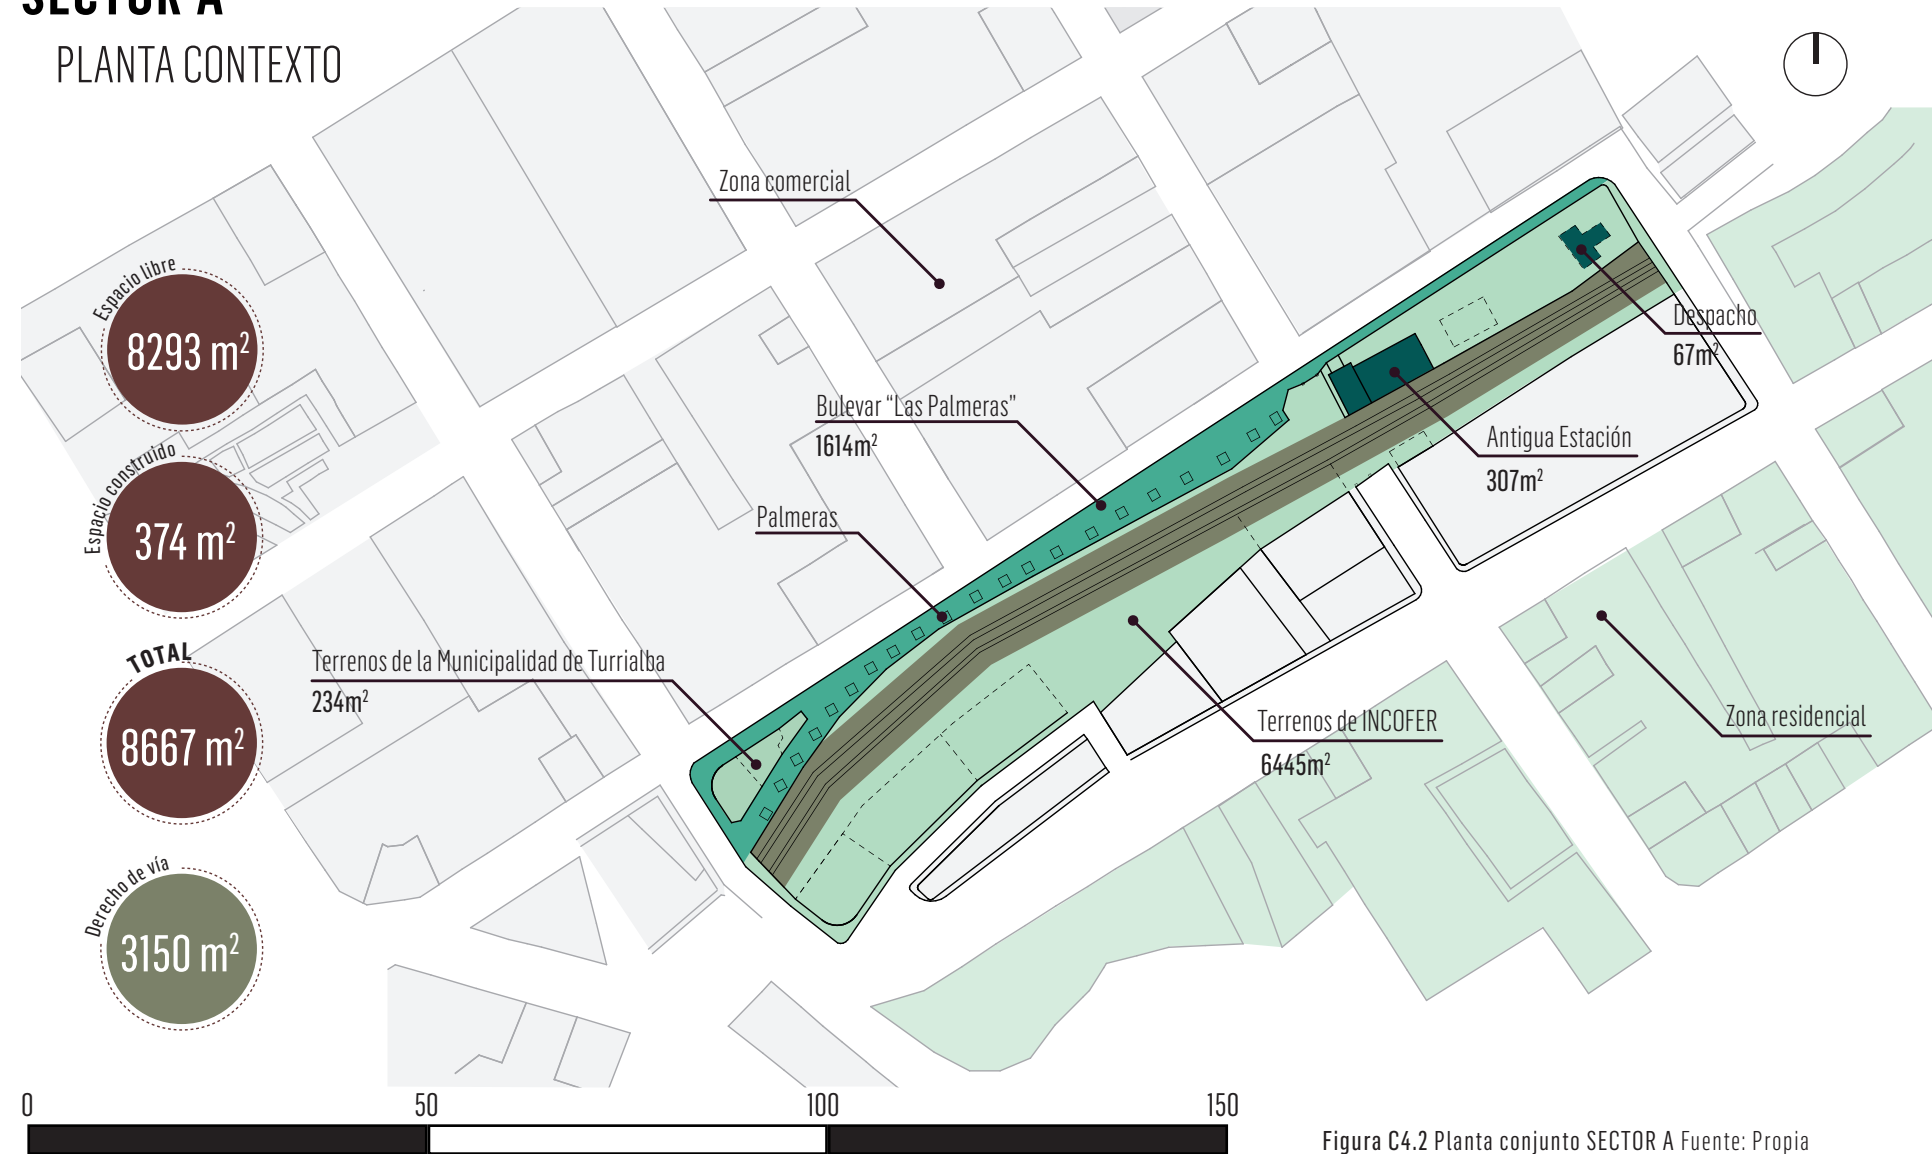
Planta conjunto SECTOR A Fuente: Propia
